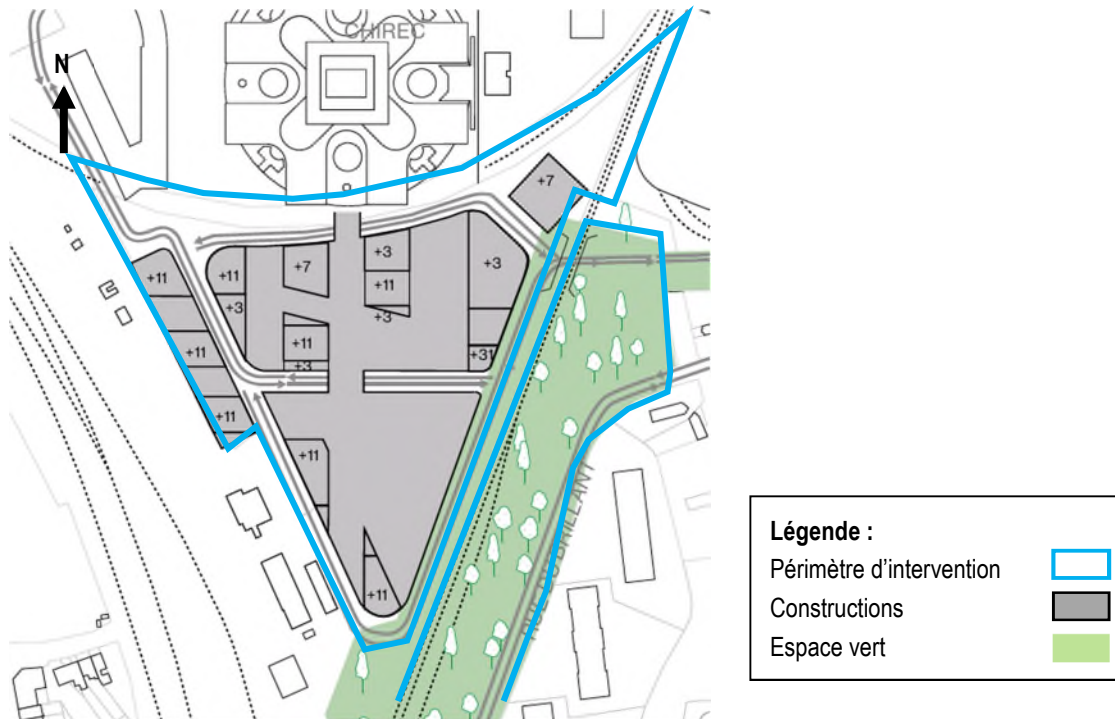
Implantation des constructions de l'alternative (ARIES sur fond ORG², 2018)
